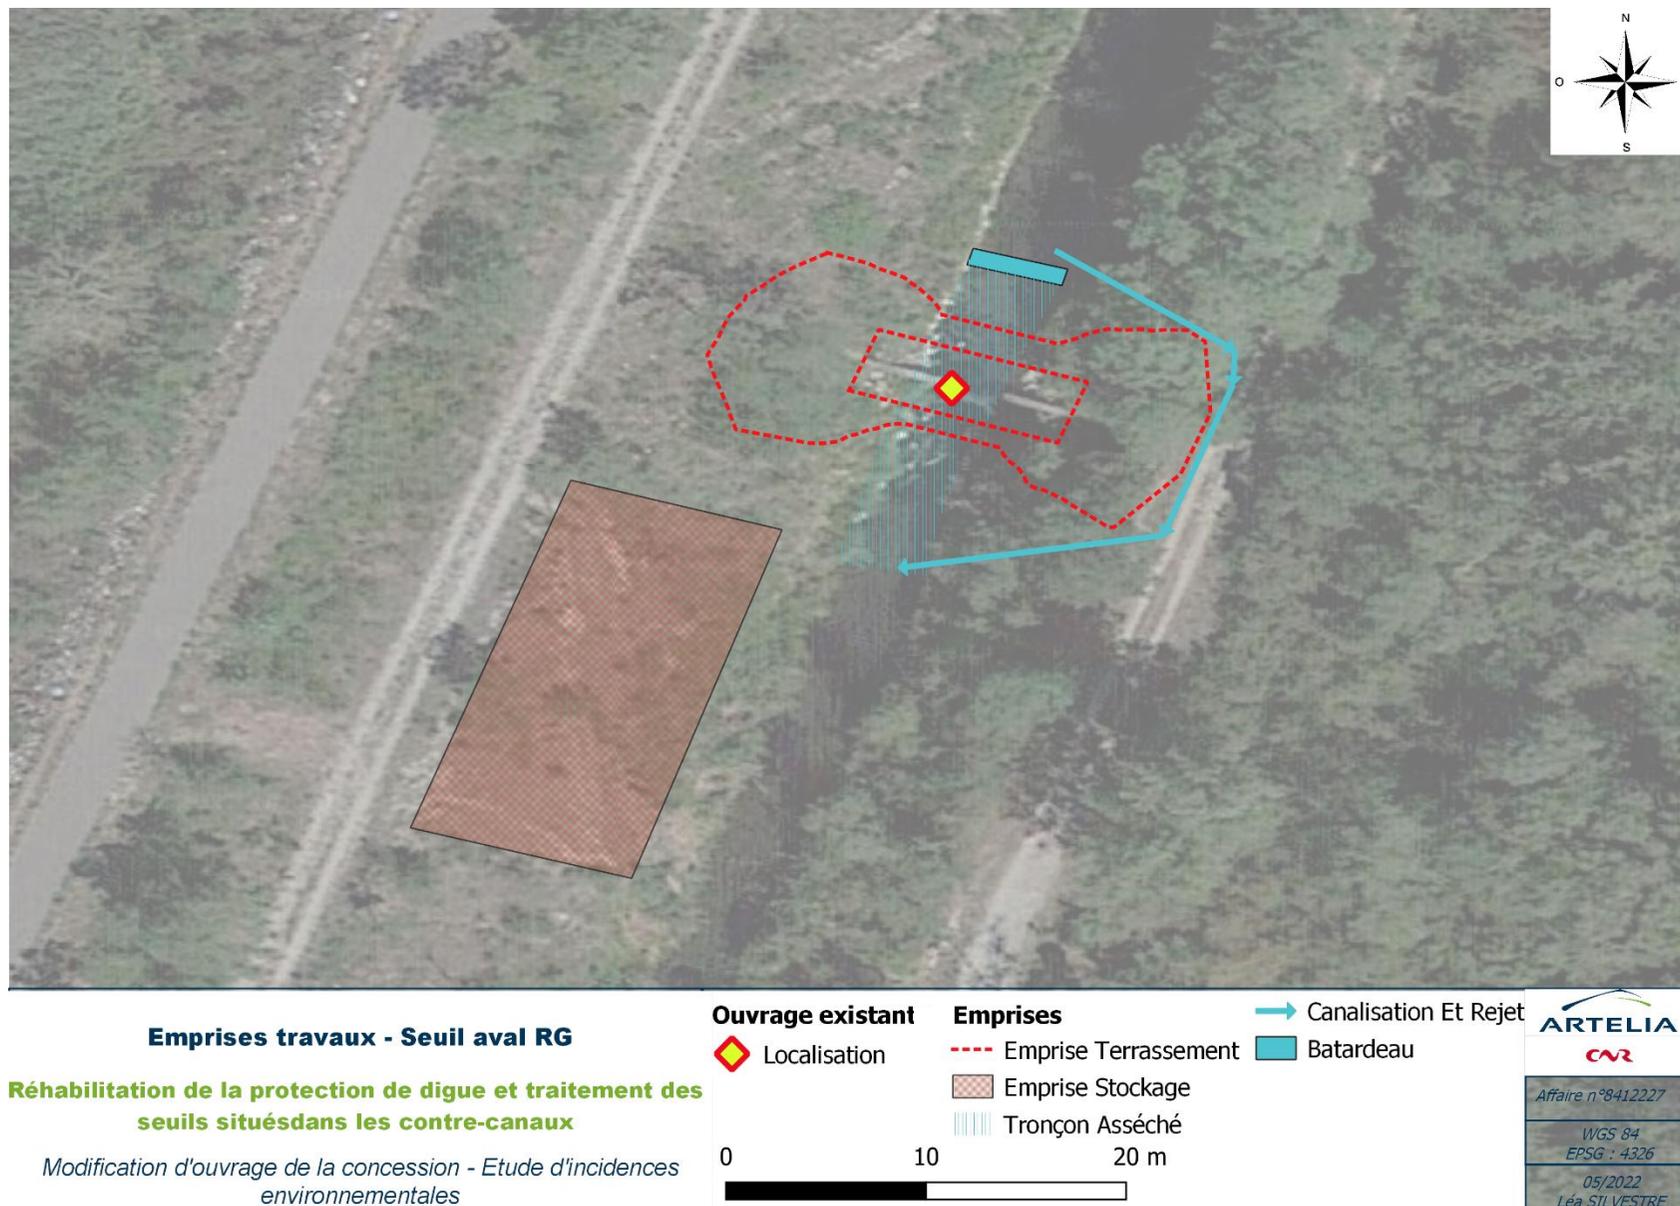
Emprise des travaux - Ouvrage RG Aval
